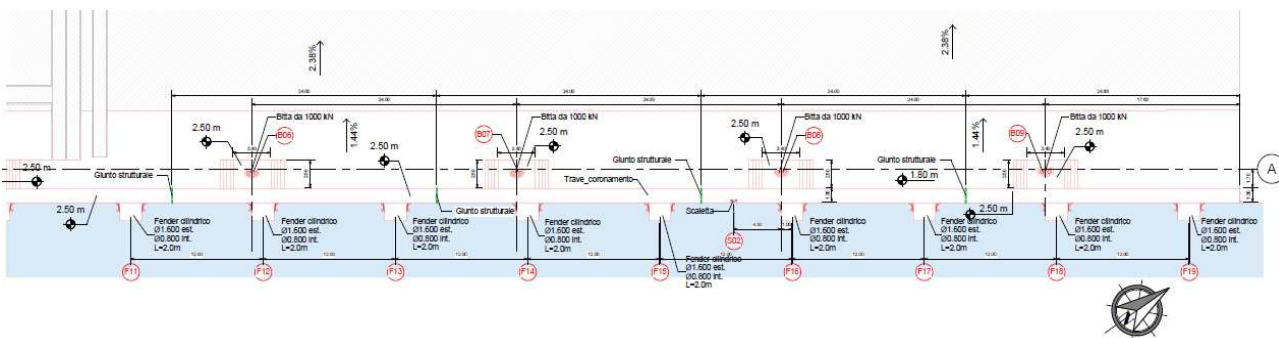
Alma – Planimetria di progetto / Quadranti 3-4.
